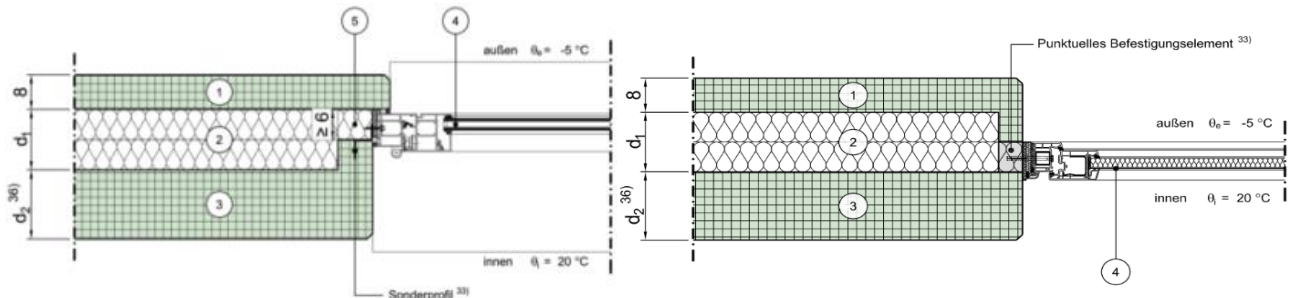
Beispiele aus dem Planungsatlas für den Hochbau für Sandwichfassaden [2]
